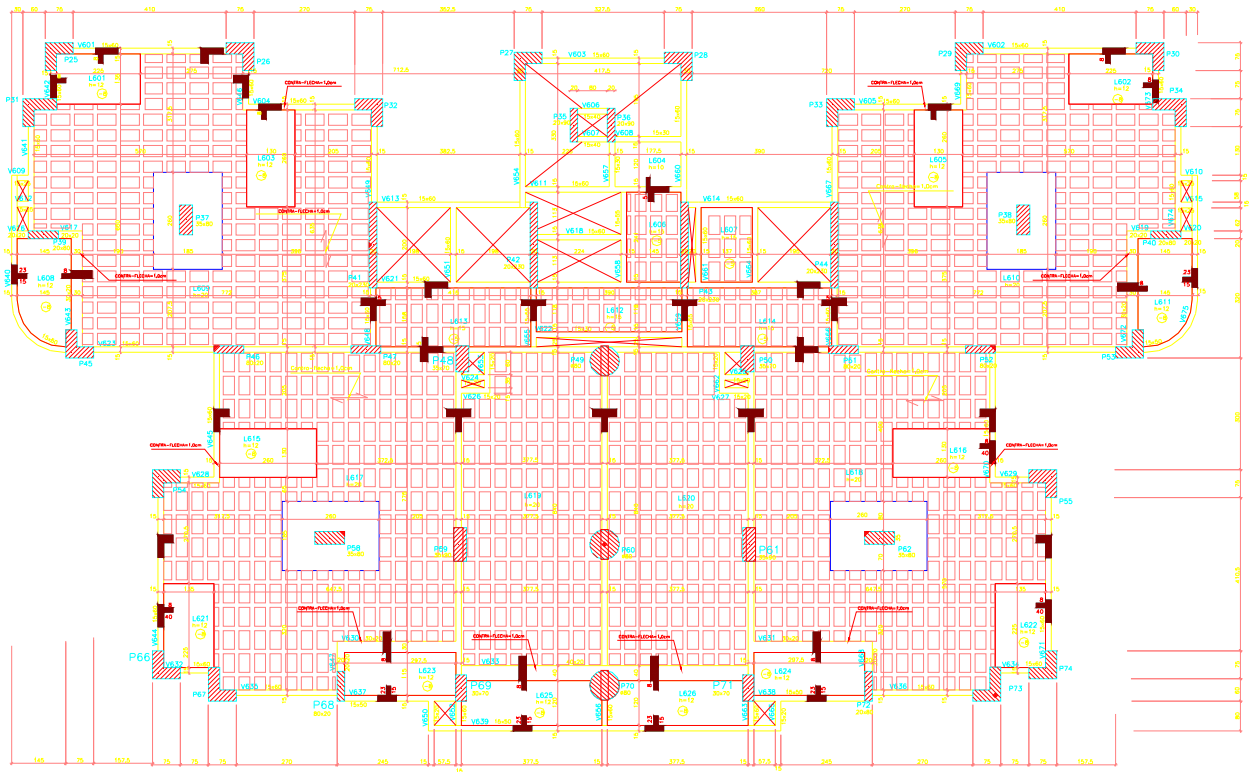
Planta de fôrma da estrutura dos pavimentos estudados.
